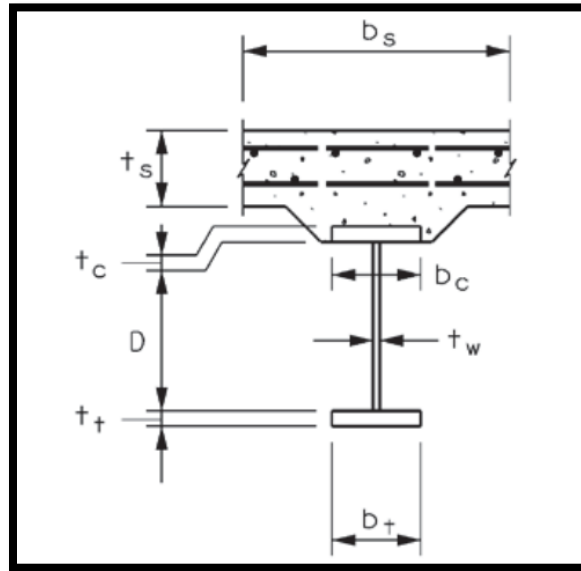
Sección transversal viga compuesta del puente (Fuente: AASHTO LRFD 2017)
